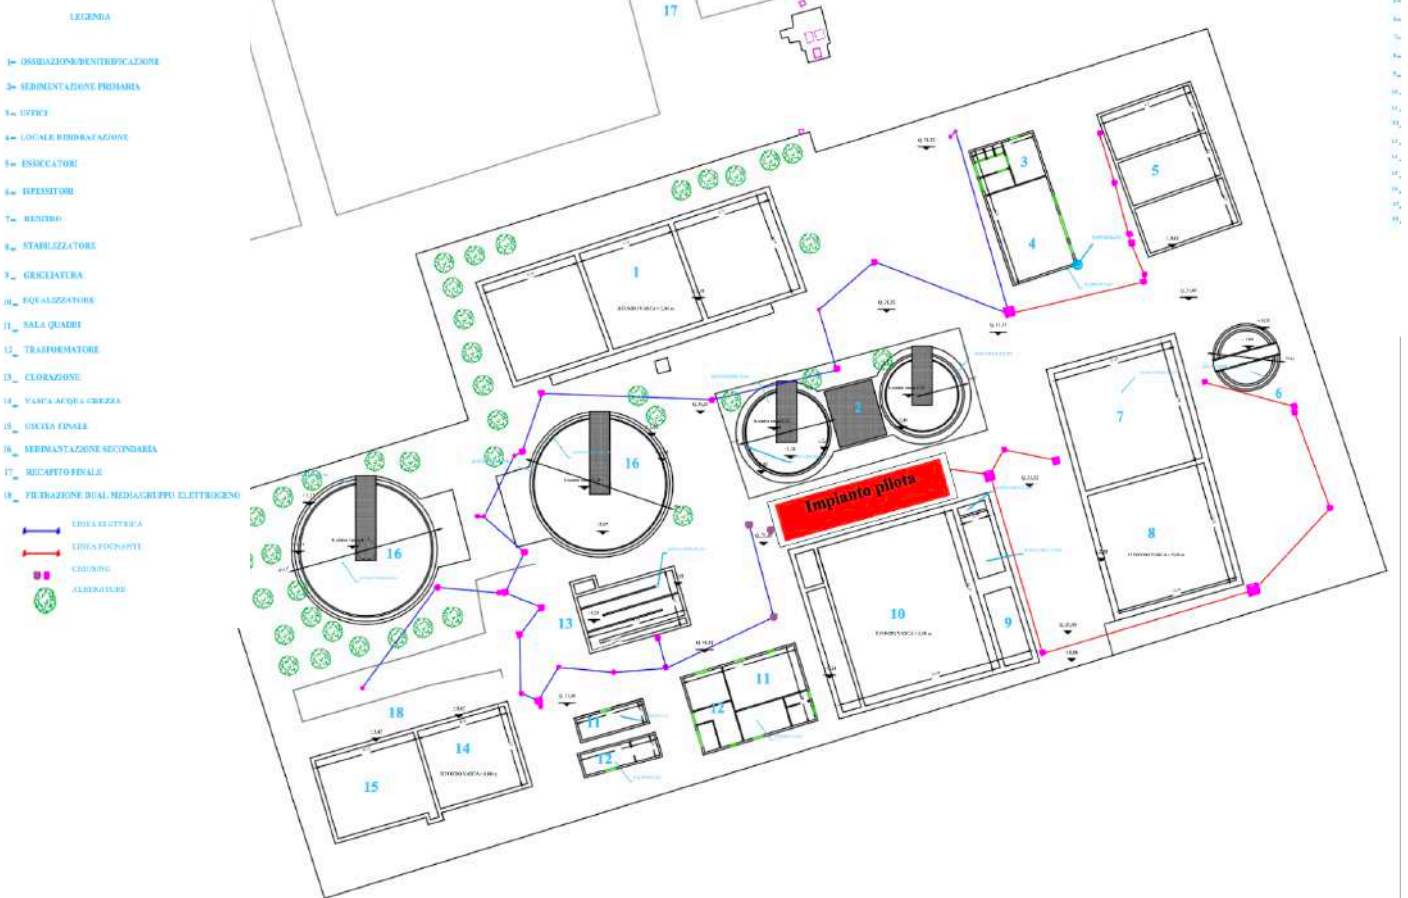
layout impianto di depurazione Vernole con ubicazione impianto pilota
